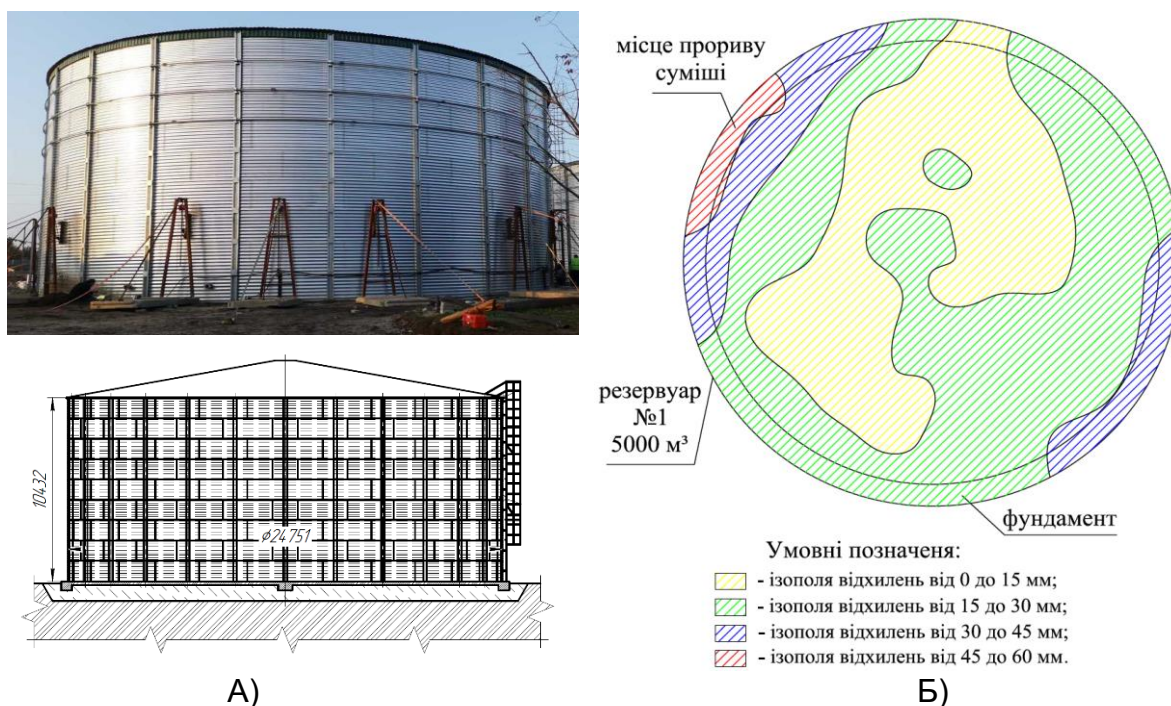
А) – Загальний вигляд та розріз резервуару для зберігання рідини;
